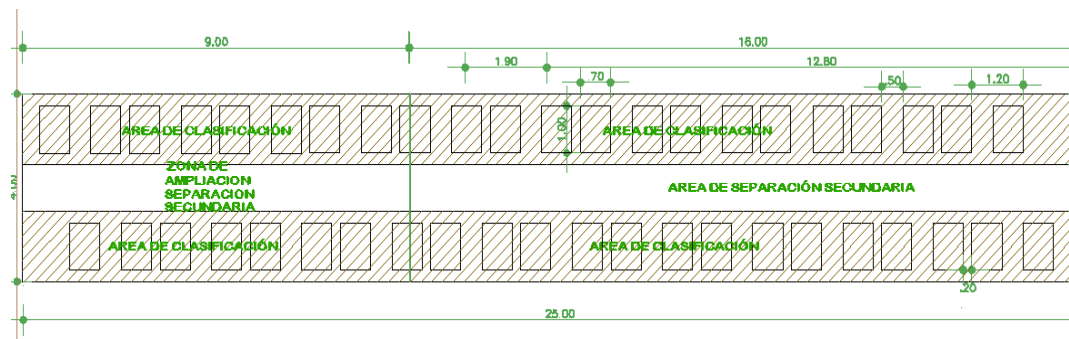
Separación secundaria de la zona de clasificación de la planta de reciclaje
